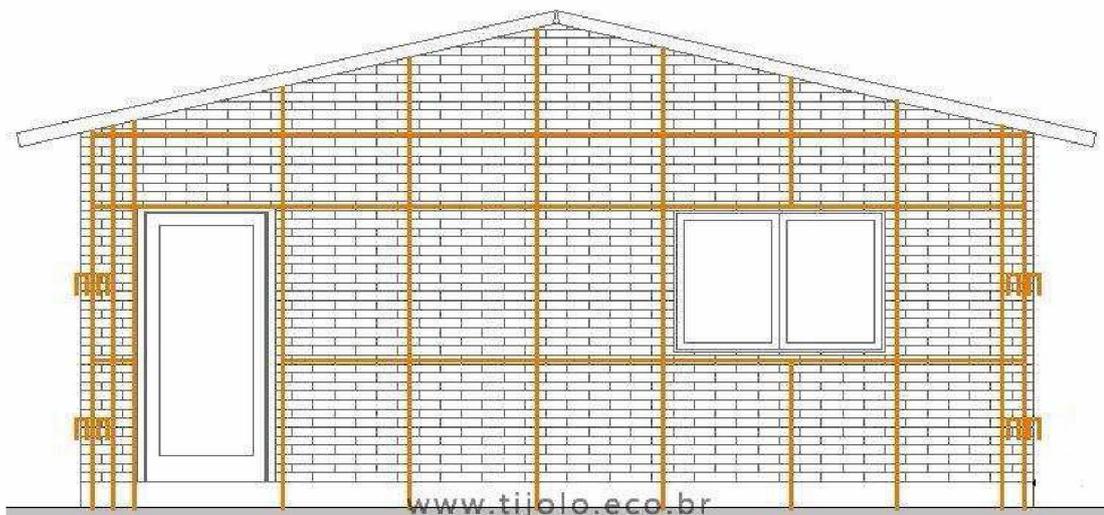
Desenho esquemático da malha estrutural do sistema construtivo modular
